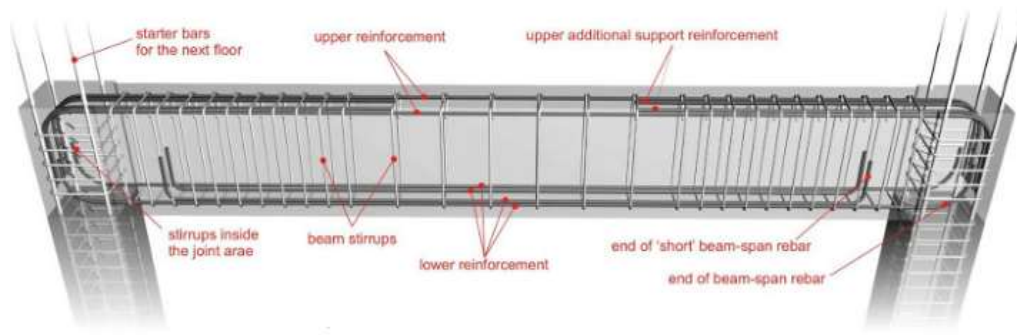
Vista típica de pórtico de concreto resistente a momentos.
